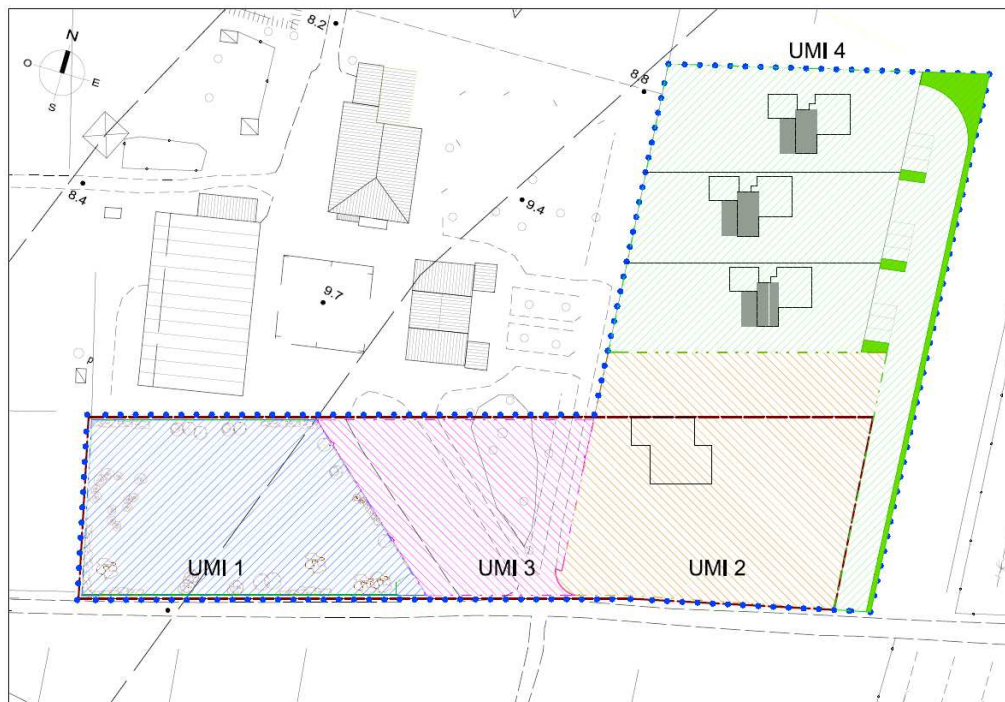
Planimetria generale di progetto – Variante generale al PdR
